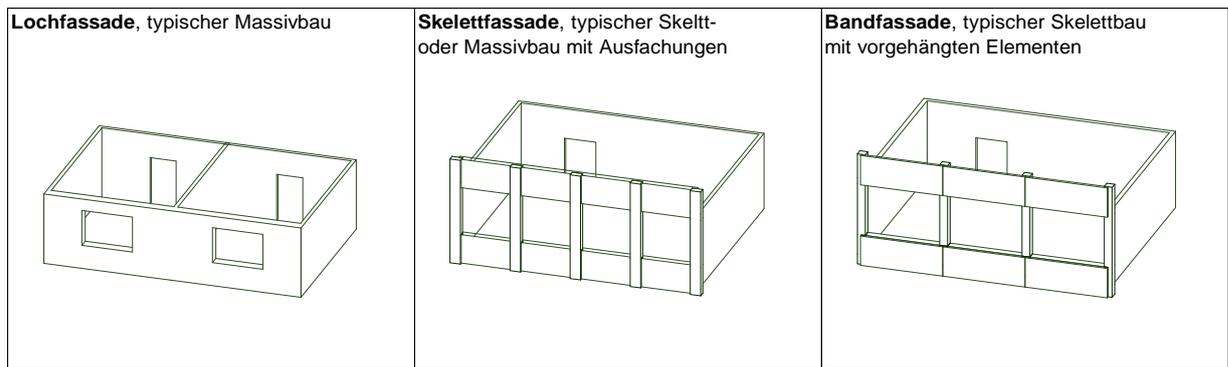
Typische Fassaden von Schulgebäuden (Lochfassade, Skelettfassade und Bandfassade)
